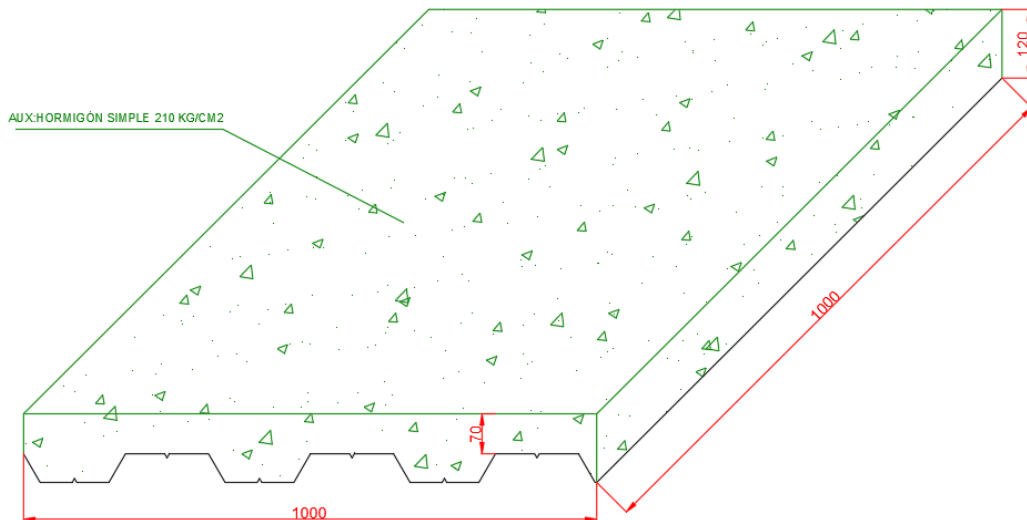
Rubro "Hormigón simple en losa deck 7cm"
